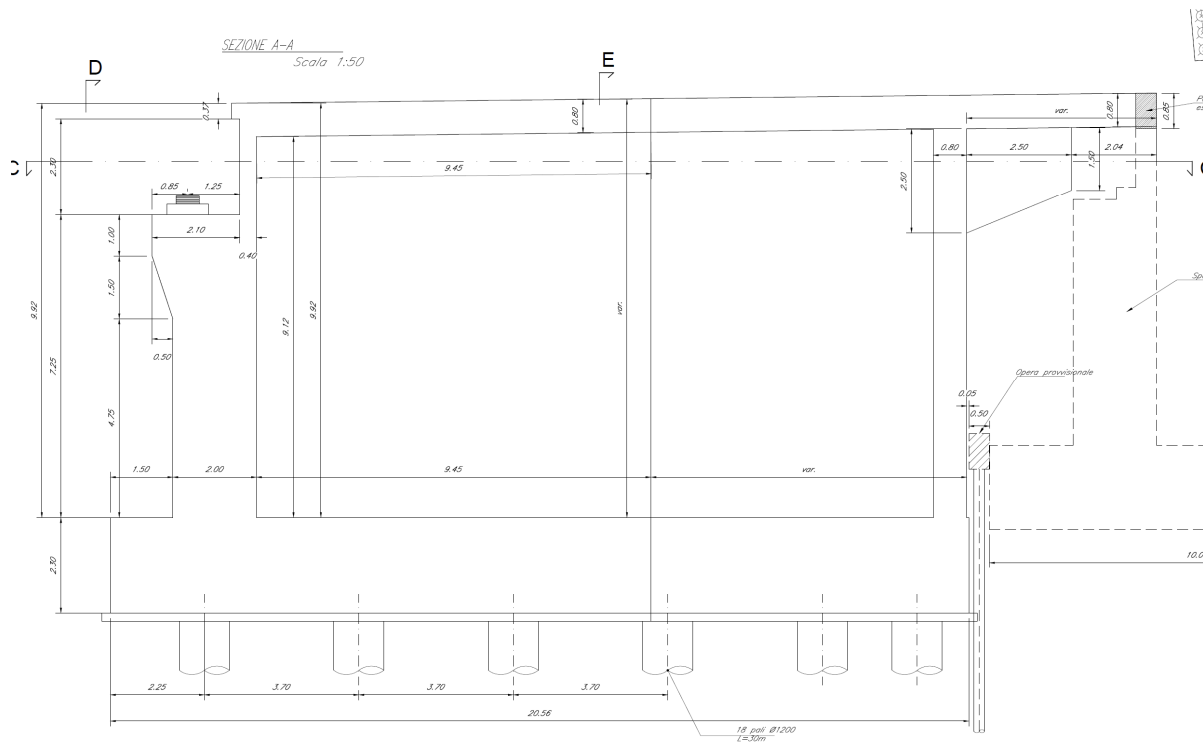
Sezione longitudinale Spalla B (lato adiacente viadotto esistente)
